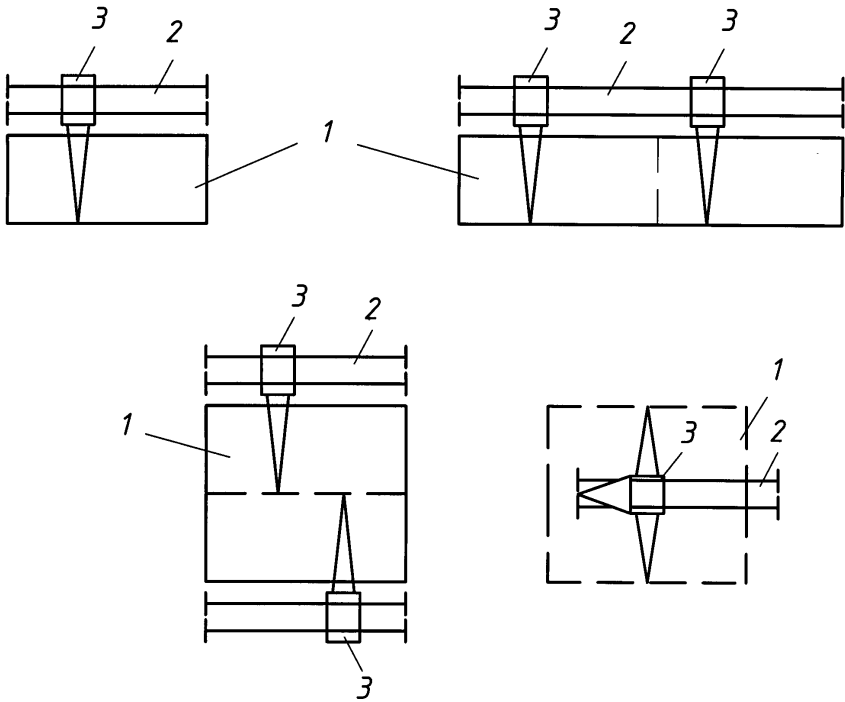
Варианты расположения башенных кранов при монтаже многоэтажных зданий: 1 – монтируемое здание; 2 – подкрановый путь; 3 – башенный кран
